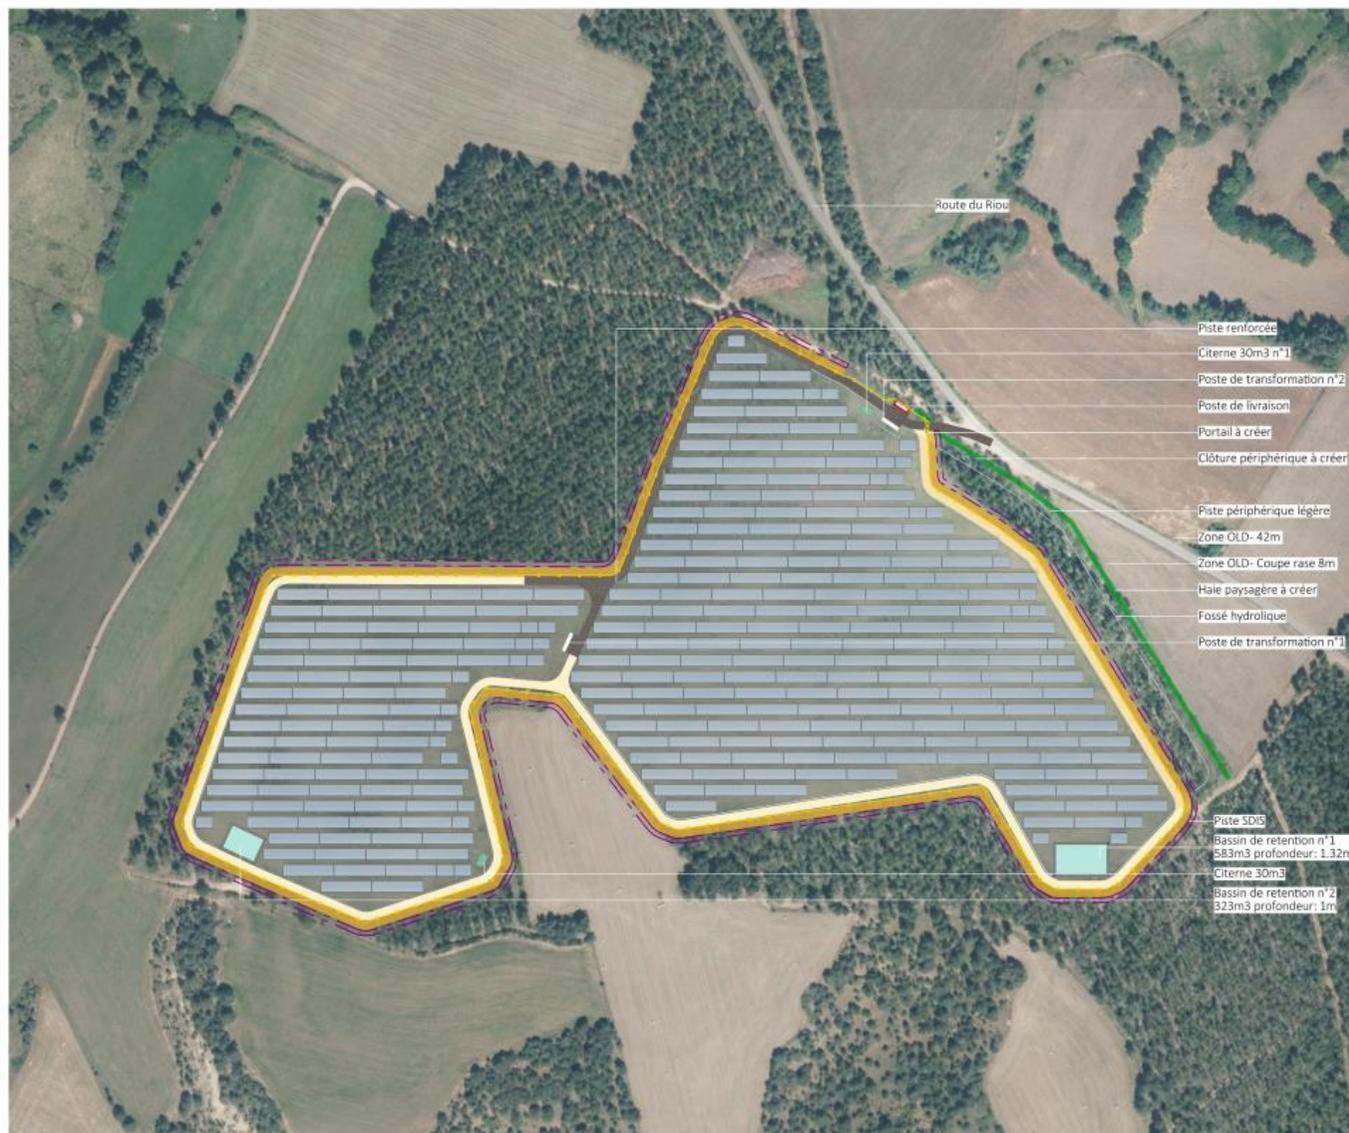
plan masse général du projet (source : permis de construire, EDF-Re, 2023)
